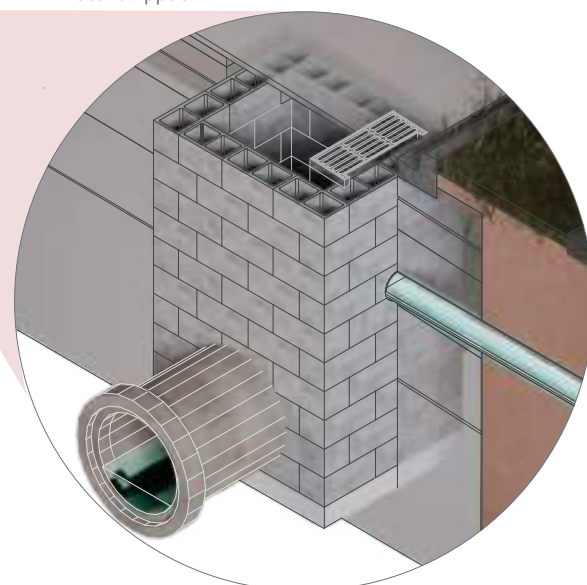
ligação da drenagem pluvial de lote à galeria de águas pluviais no logradouro público
